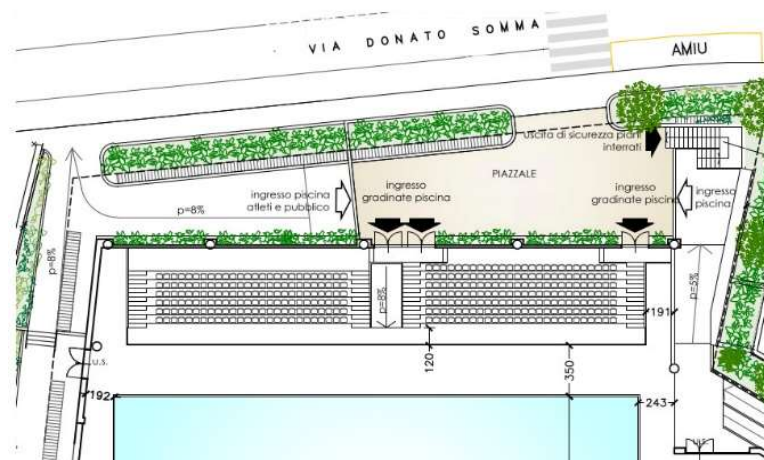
pianta piano gradinate con ingresso da via Somma
